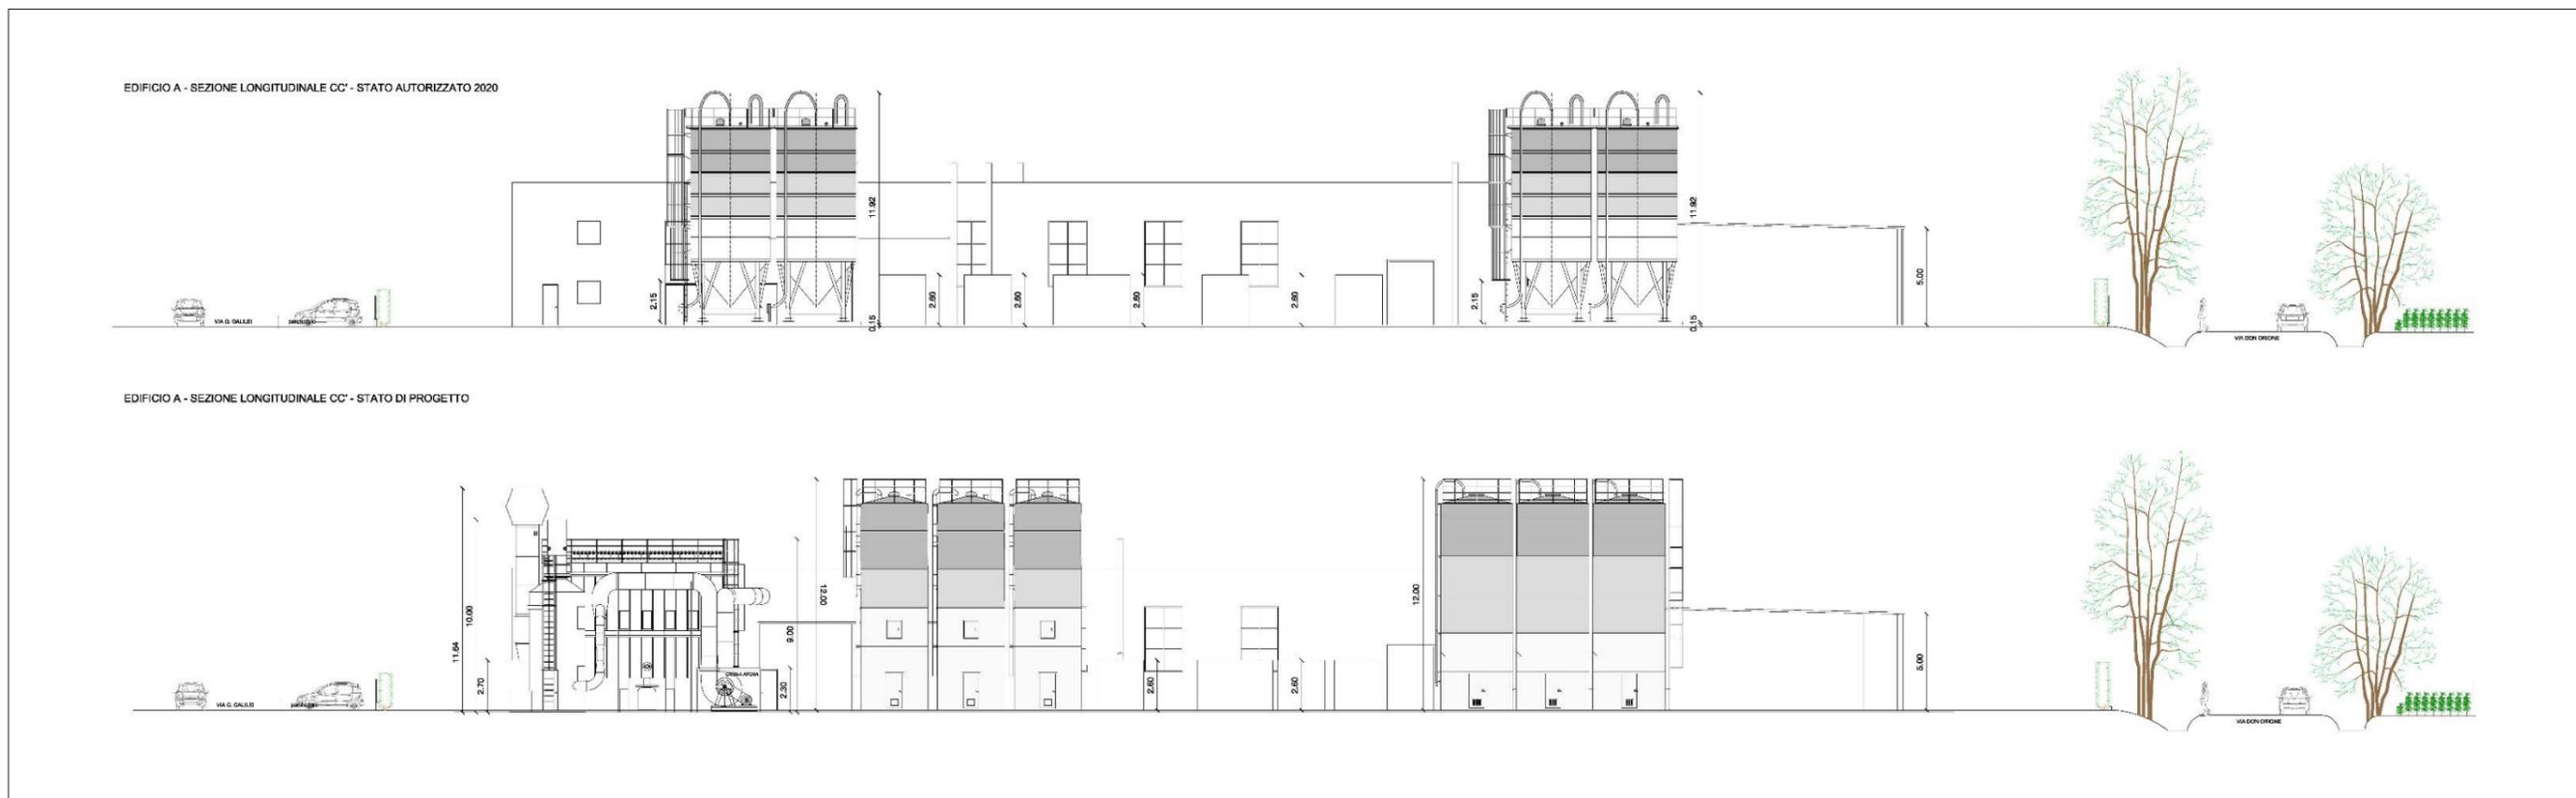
Prospetto N, configurazione autorizzata (in alto) e configurazione di progetto (in basso)
